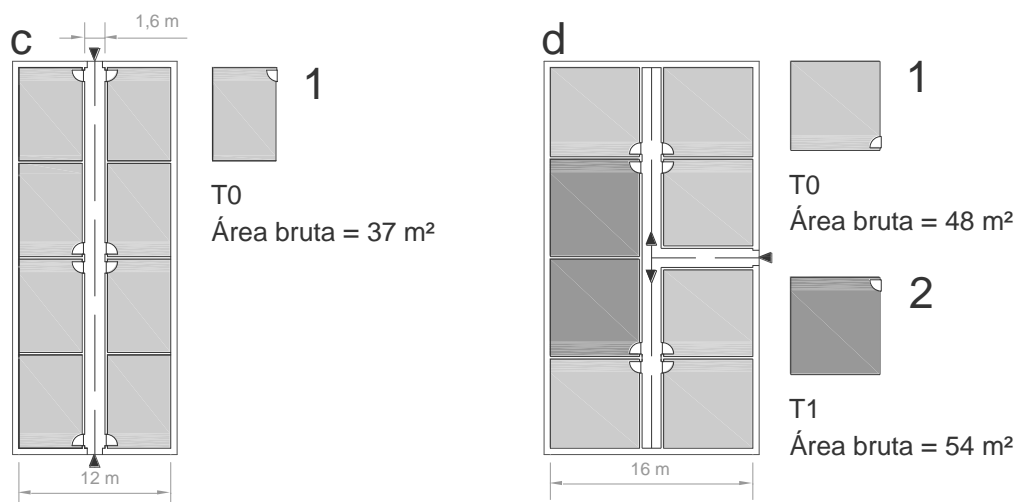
Divisão do espaço interior em frações para pisos com 12 e 16 metros de largura.
